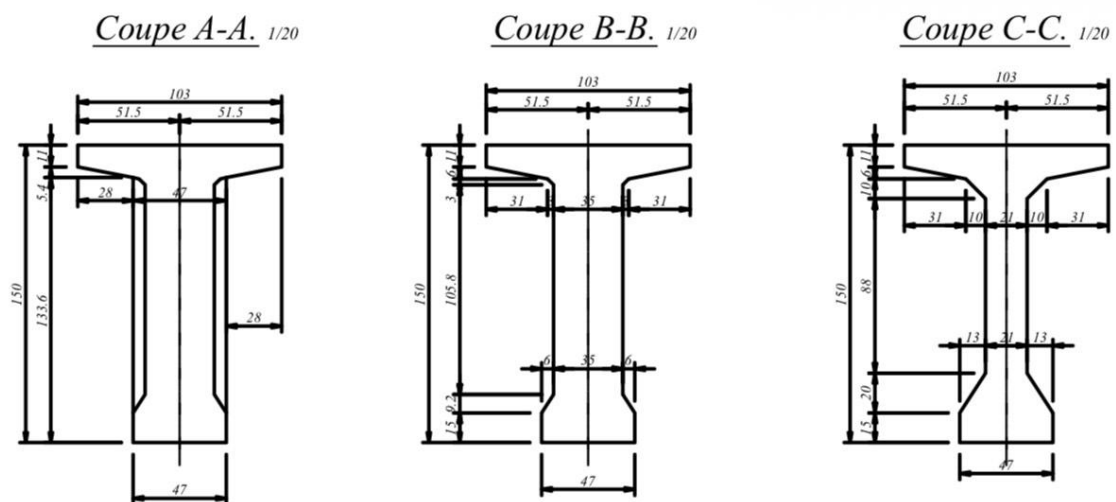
Sections transversales de la poutre de travée intermédiaire
